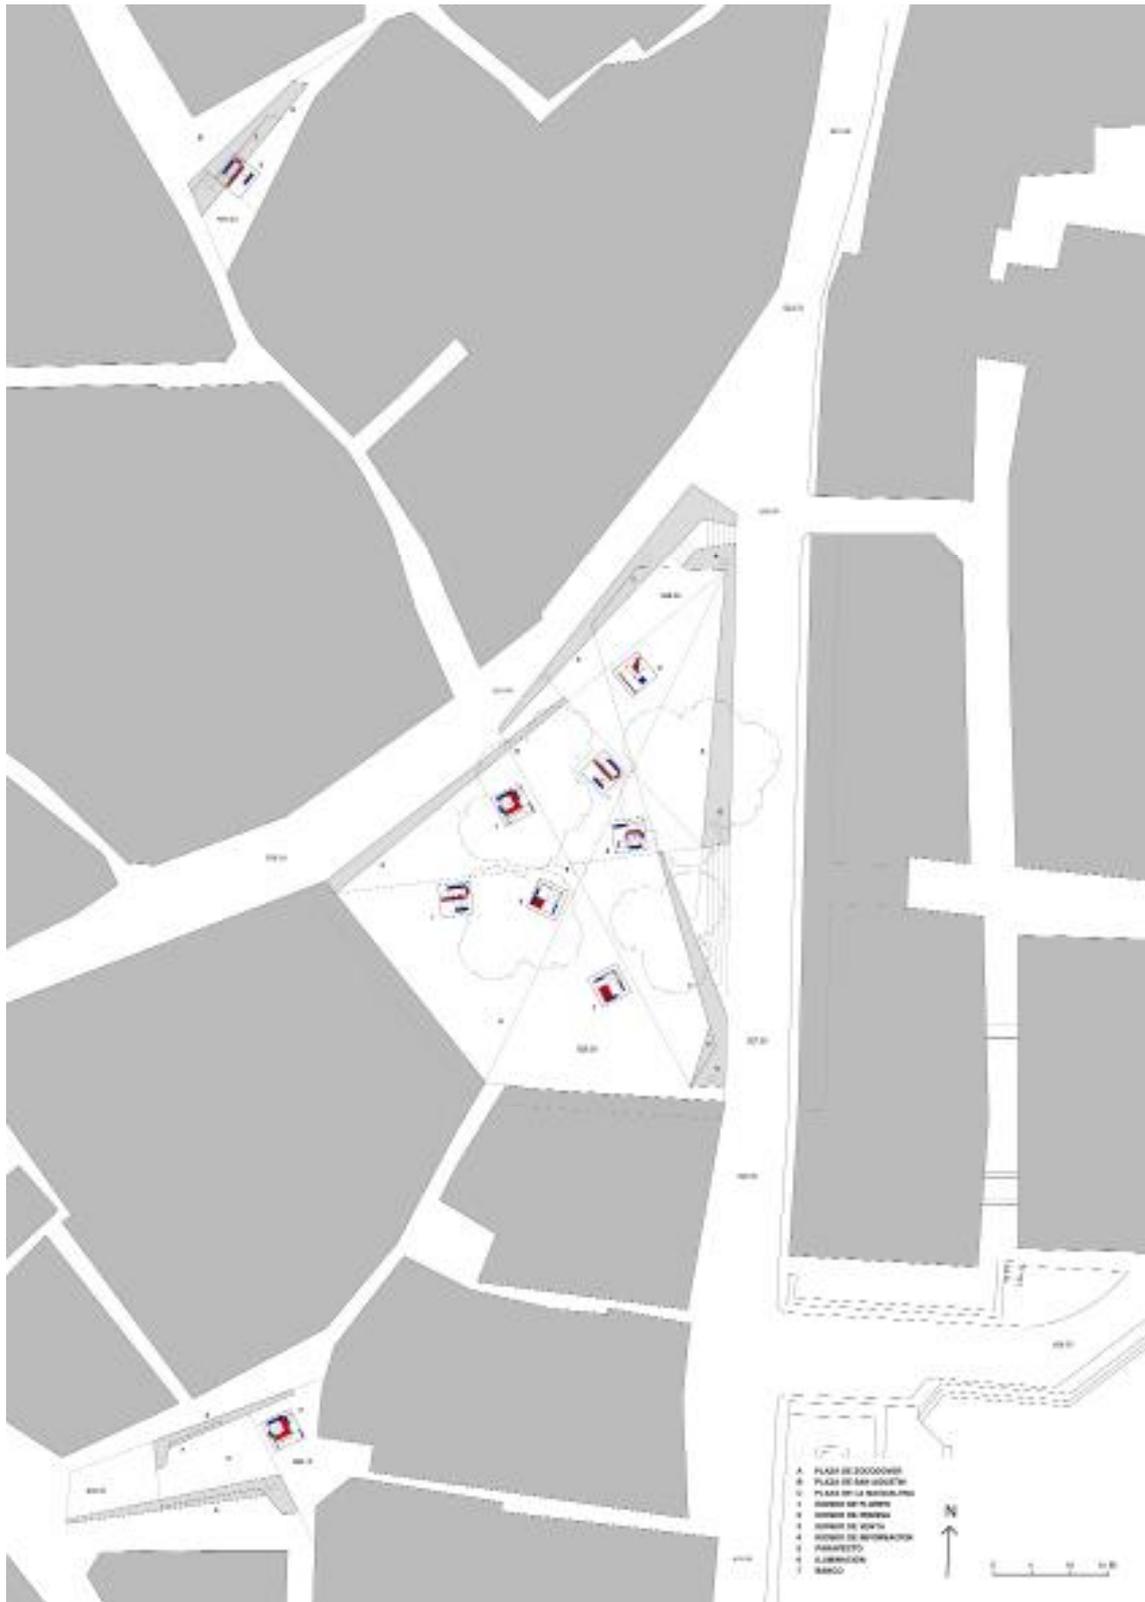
A. Monaco. Toledo, planimetria della plaza Zocodover
